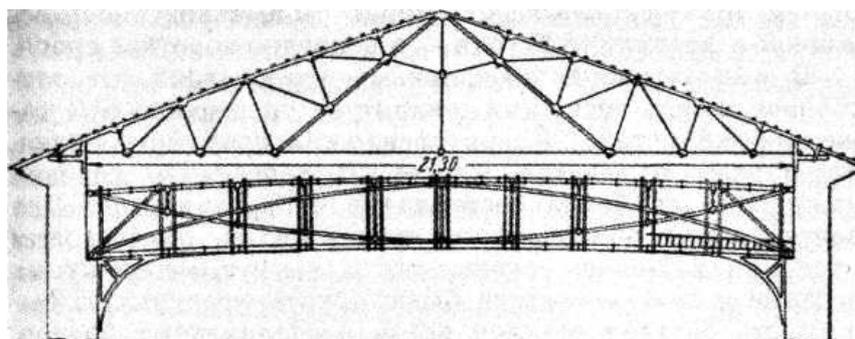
Чугунная арка пролетом 30 м перекрытия Александринского театра в Петербурге (1827 - 1832 гг.)
